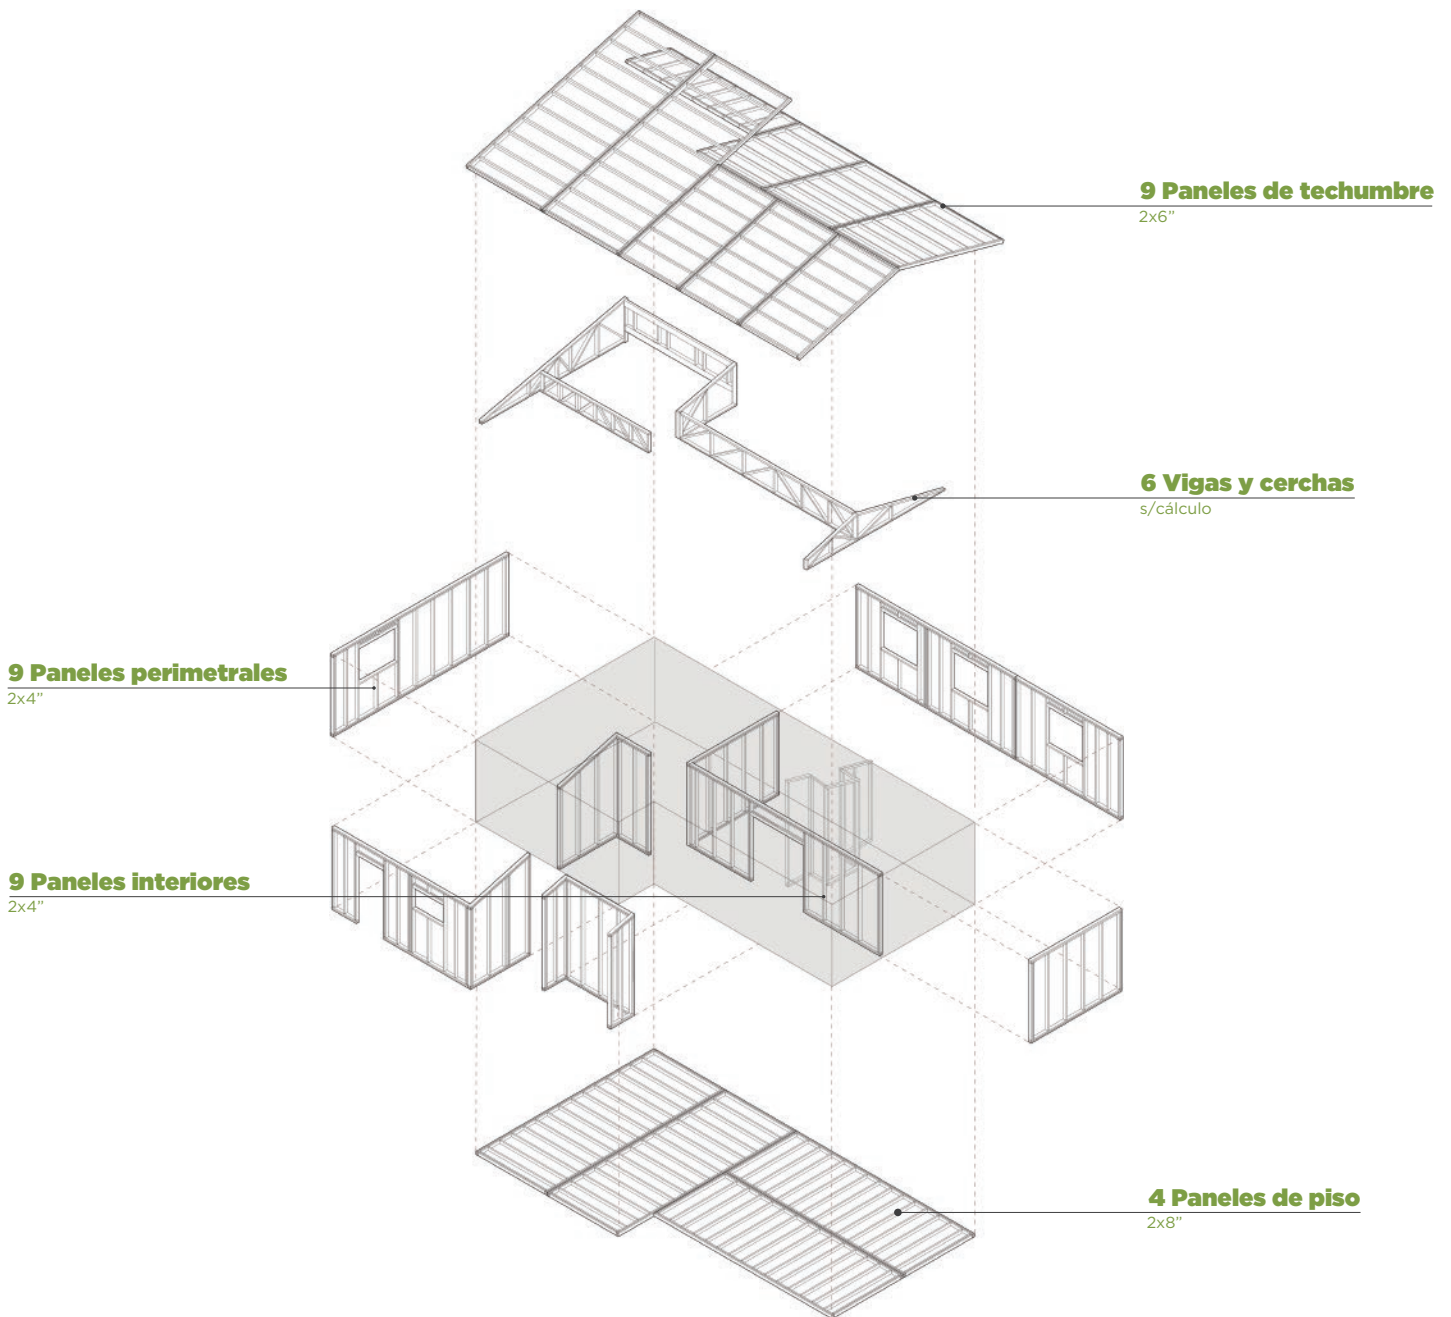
Axonométrica desplegada vivienda. Estructura de elementos prefabricados: paneles, vigas y cerchas.
